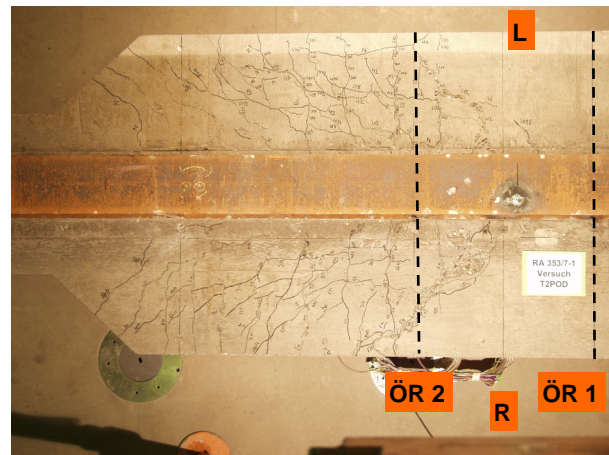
Rissbild auf der Betongurtunterseite
